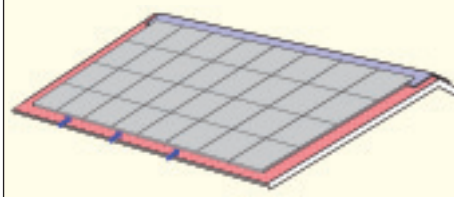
Fotovoltaik auf bestehendem Dach mit Luftführung giebelwärts und Giebelabdeckung
